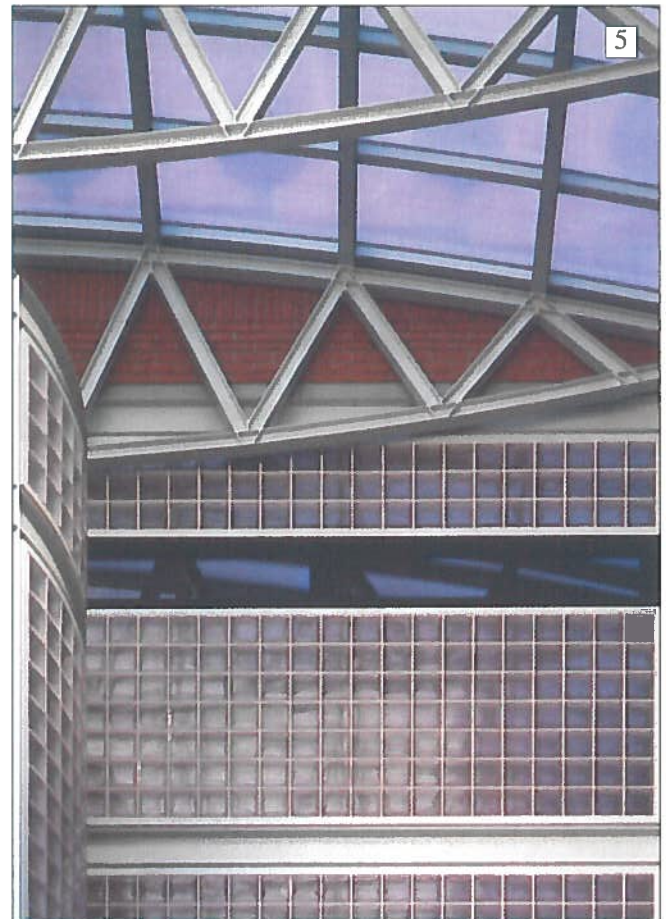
Centro Cinque Continenti, Lugano. Dettaglio dell'ultima trave reticolare della copertura accostata al rivestimento in mattoni faccia a vista.
